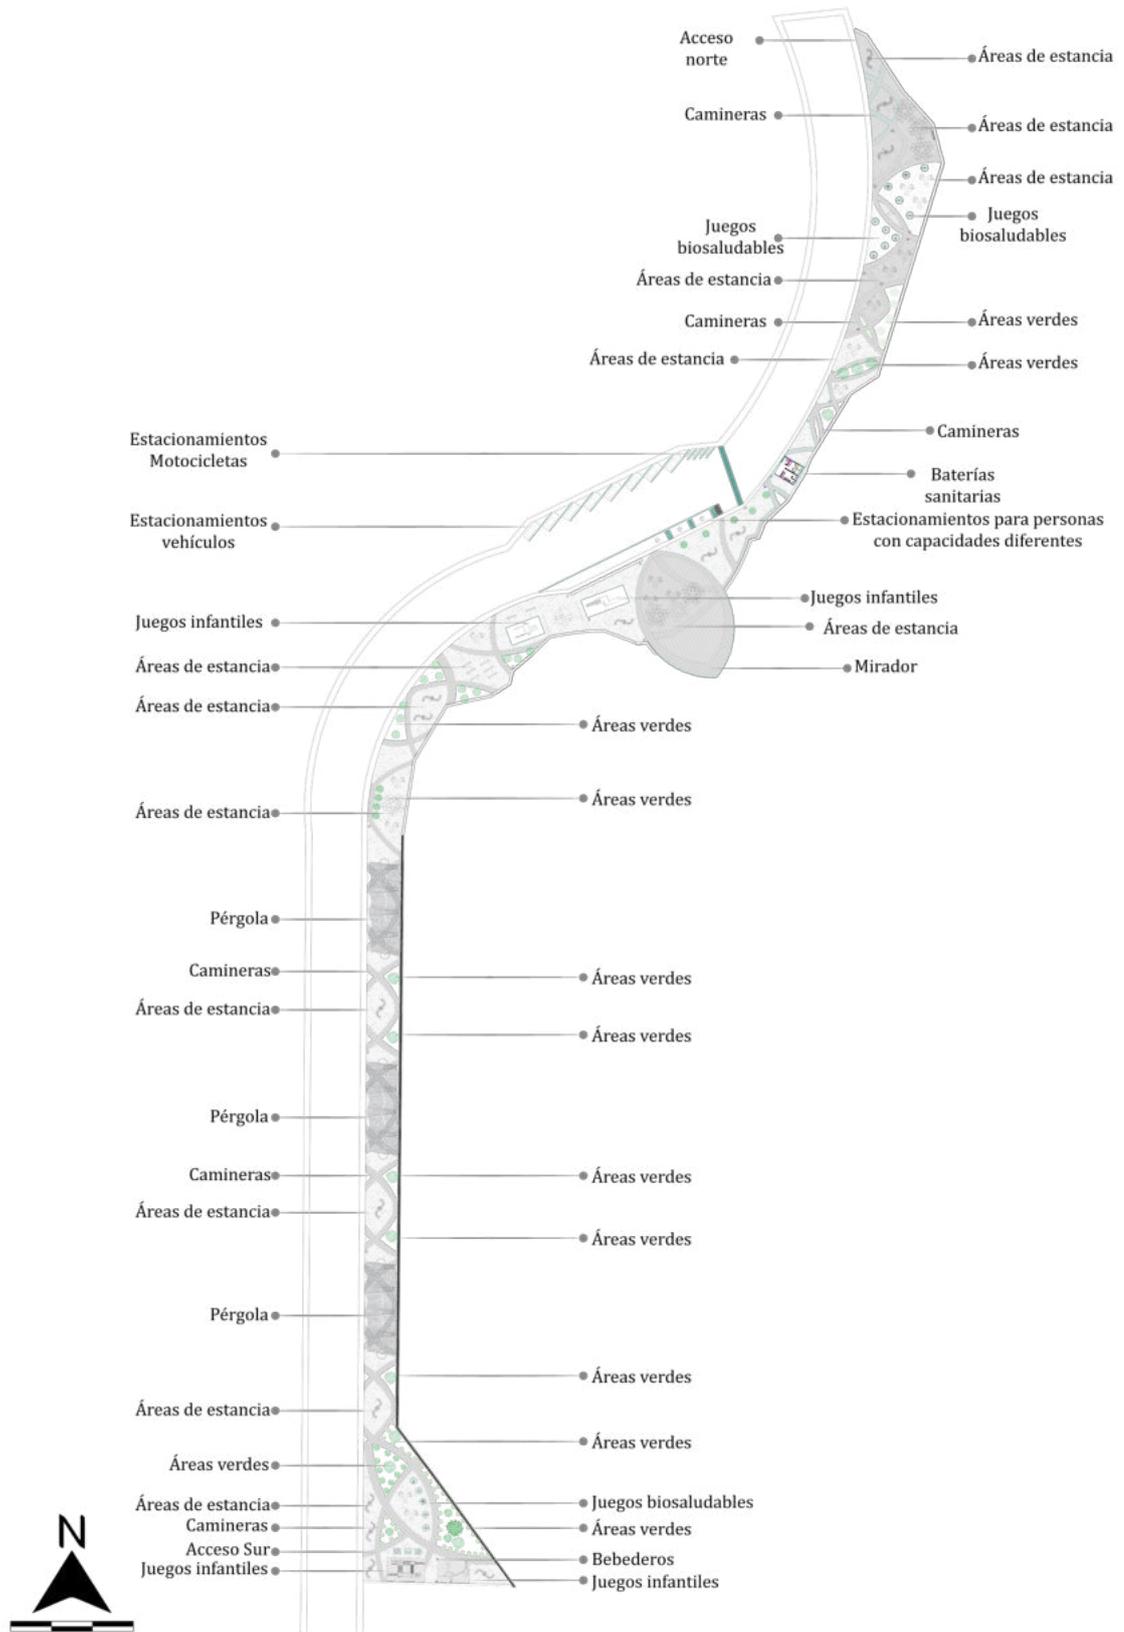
Plano 1–Planta arquitectónica espacios propuestos. Fuente: Elaboración propia
